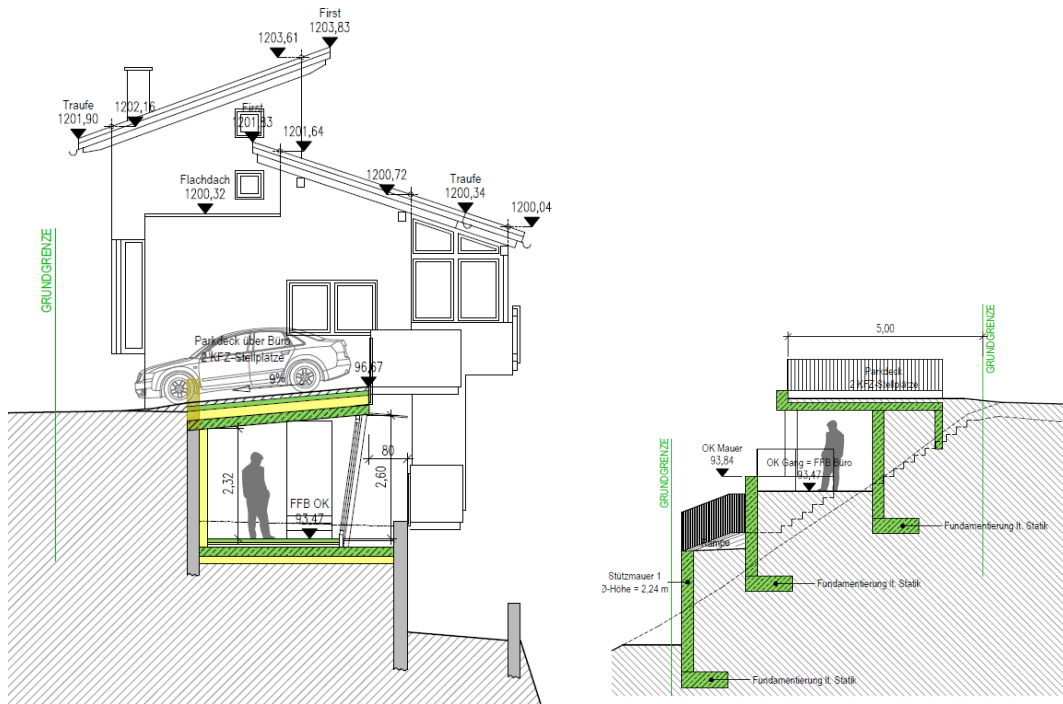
Schnitte A-A (links) und B-B (rechts) des westlichen Zubauvorhabens am Bestandsgebäude auf der Gp. 947/34 seitens des Planungsbüros R&S Planbau mit der Projektnummer „21-029“ und dem Plandatum 23.03.2022 (ohne Maßstab).
